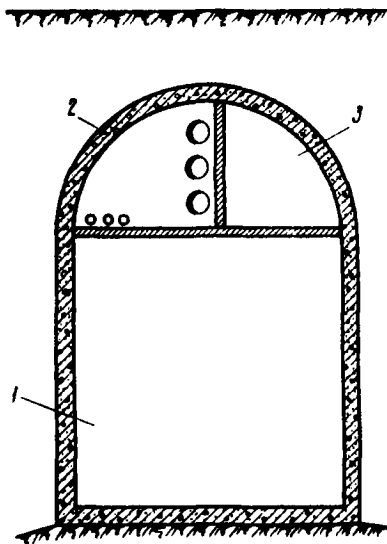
Вентиляционные каналы в подземных сооружениях:
